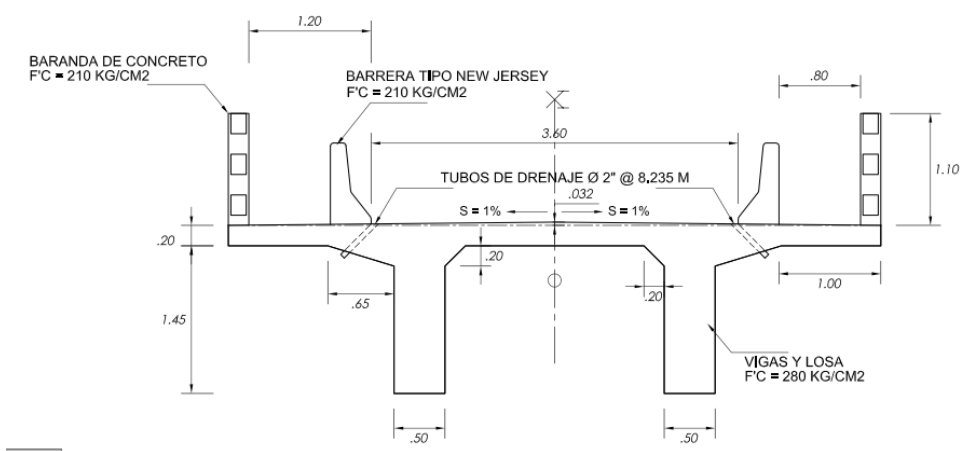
Sección transversal de la superestructura. (P-1 Anexo4)
